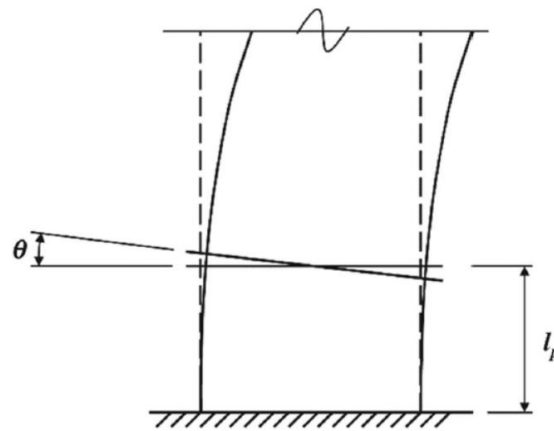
Rotación de rótula plástica en un muro de corte predominado por flexión (Sacado de ASCE 41-17)
